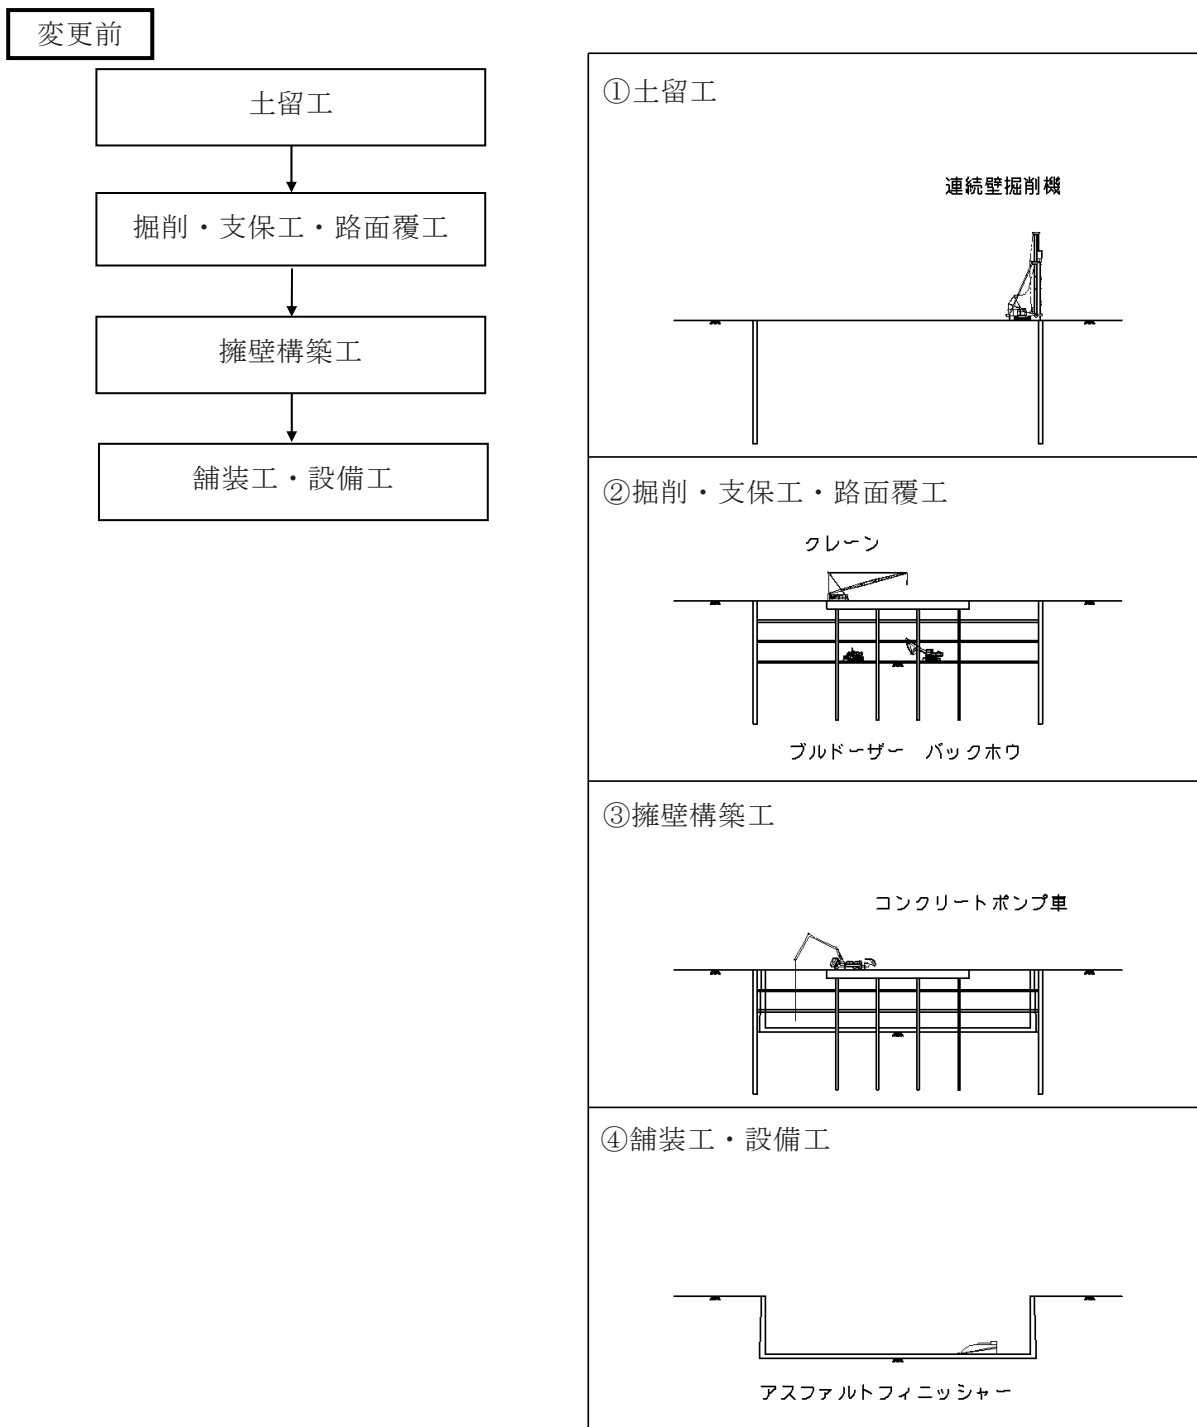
土工工事（一部区間）の施工順序（変更前）
